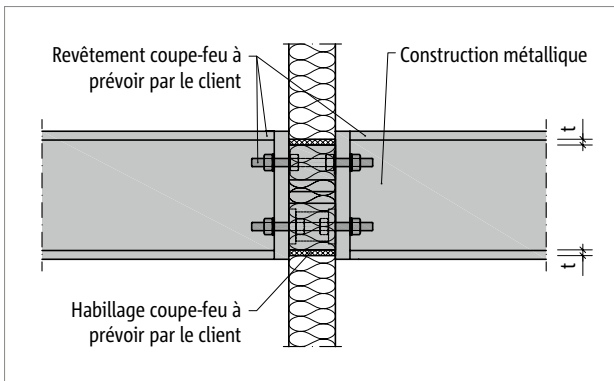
Protection incendie Schöck Isokorb® T type S : Bardage de protection incendie sur site - T type S, construction en acier avec revêtement de protection incendie ; coupe
